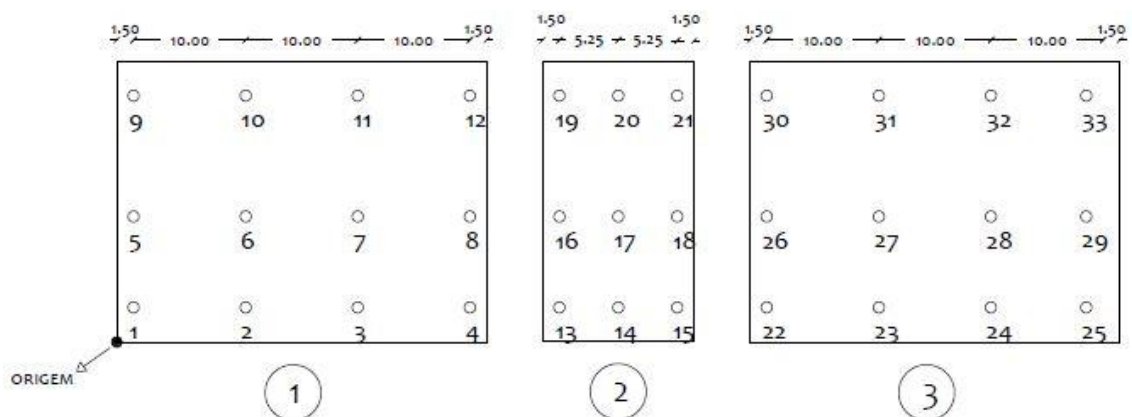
Localização das coordenadas nas fachadas 1, 2 e 3
